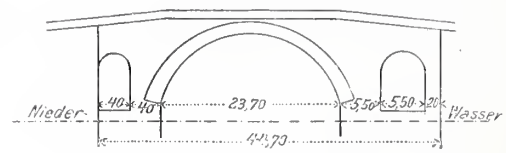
Ponte Cestio. — Alt. 1:1000.
